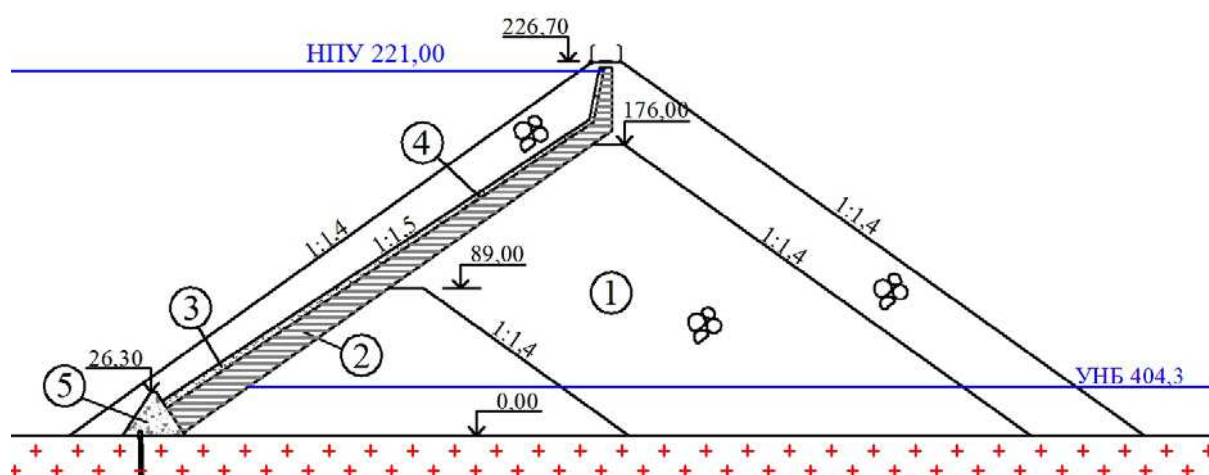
Конструкция плотины с грунтоцементобетонным экраном.
